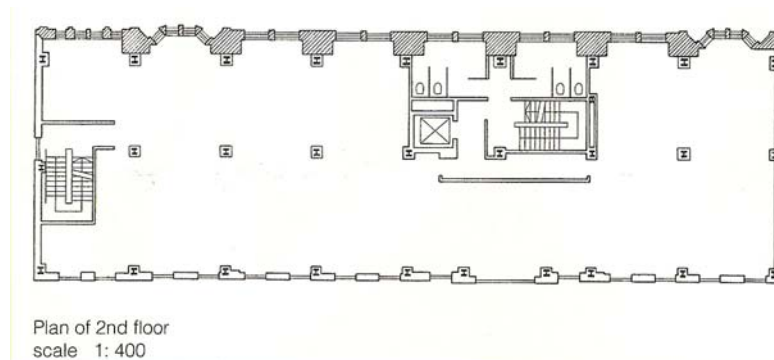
Planta do edifício comercial, Manchester, UK.
